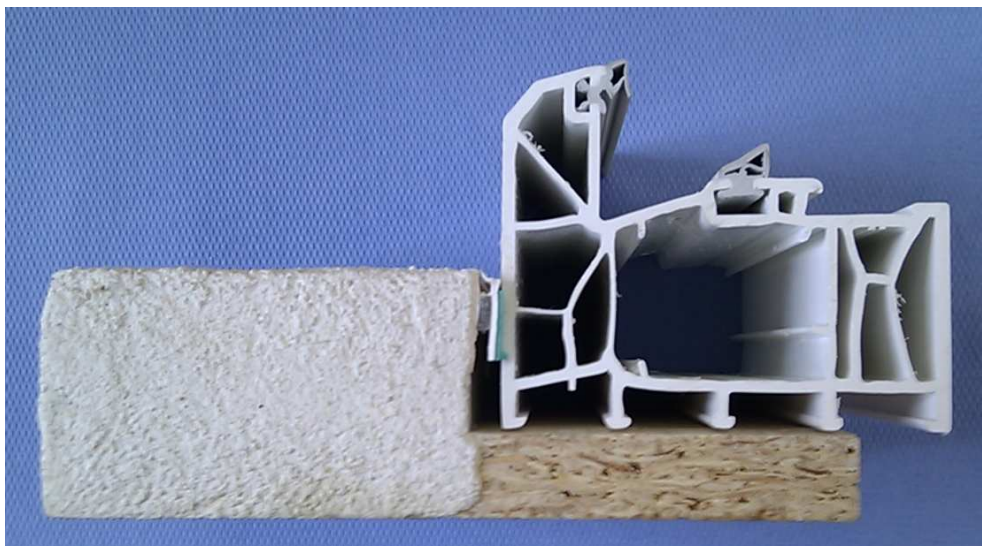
Probekörperaufbau für Prüfungen nach Abschnitt 4.1, 4.2, 4.3 und 4.4
